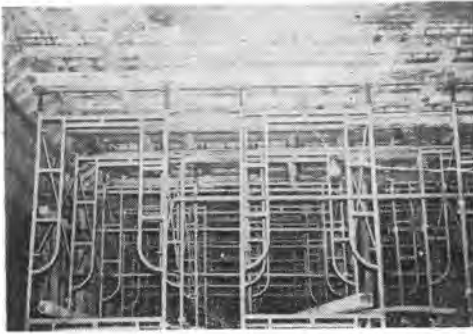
コンクリート工—メタルフォームおよびパイプサポート使用状況
